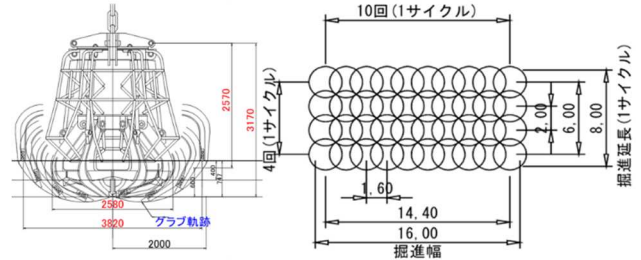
軟衝撃グラブ 図-8 浚渫1サイクル平面図
